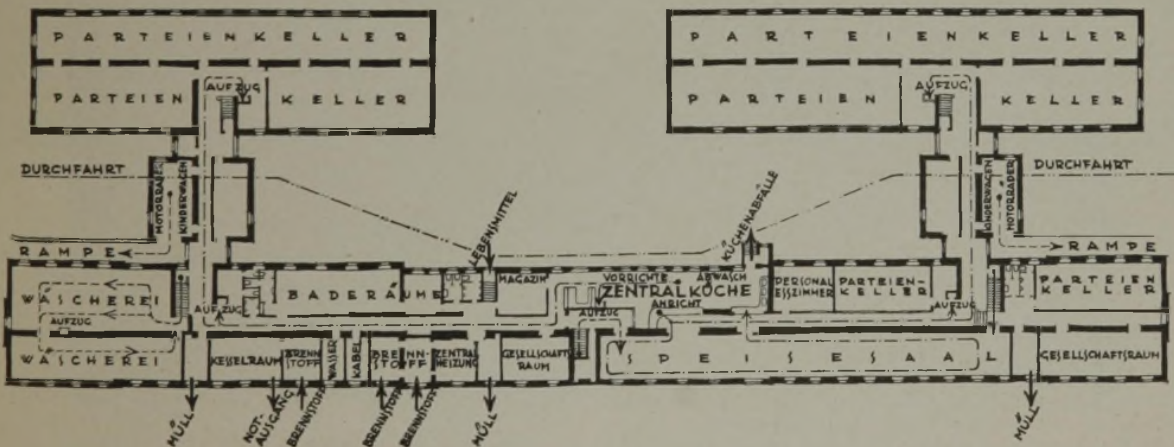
Untergeschoß-Grundriß des Familien-Einküchenhauses in Wien XV. Pilgrimgasse. (1 : 800.)
